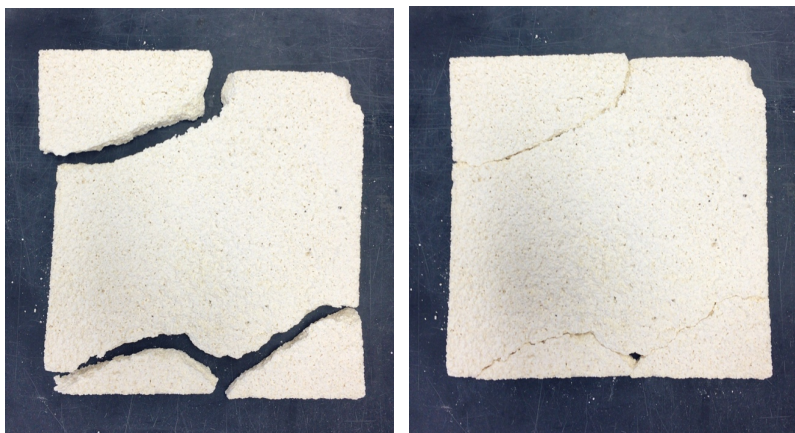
Provette destinado ao ensaio HFM1 após fissuração
